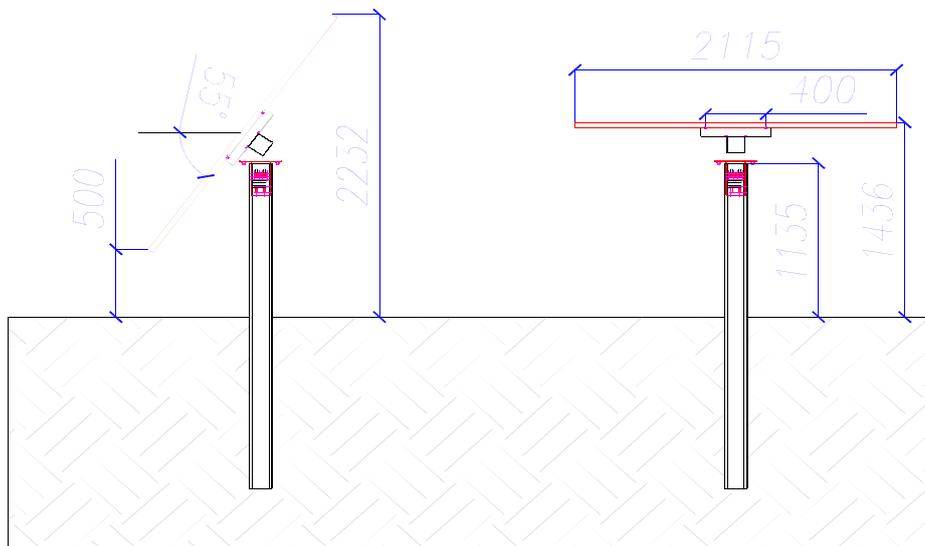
PARTICOLARE DELL'INSTALLAZIONE OMEGA E MONTAGGIO MODULI
